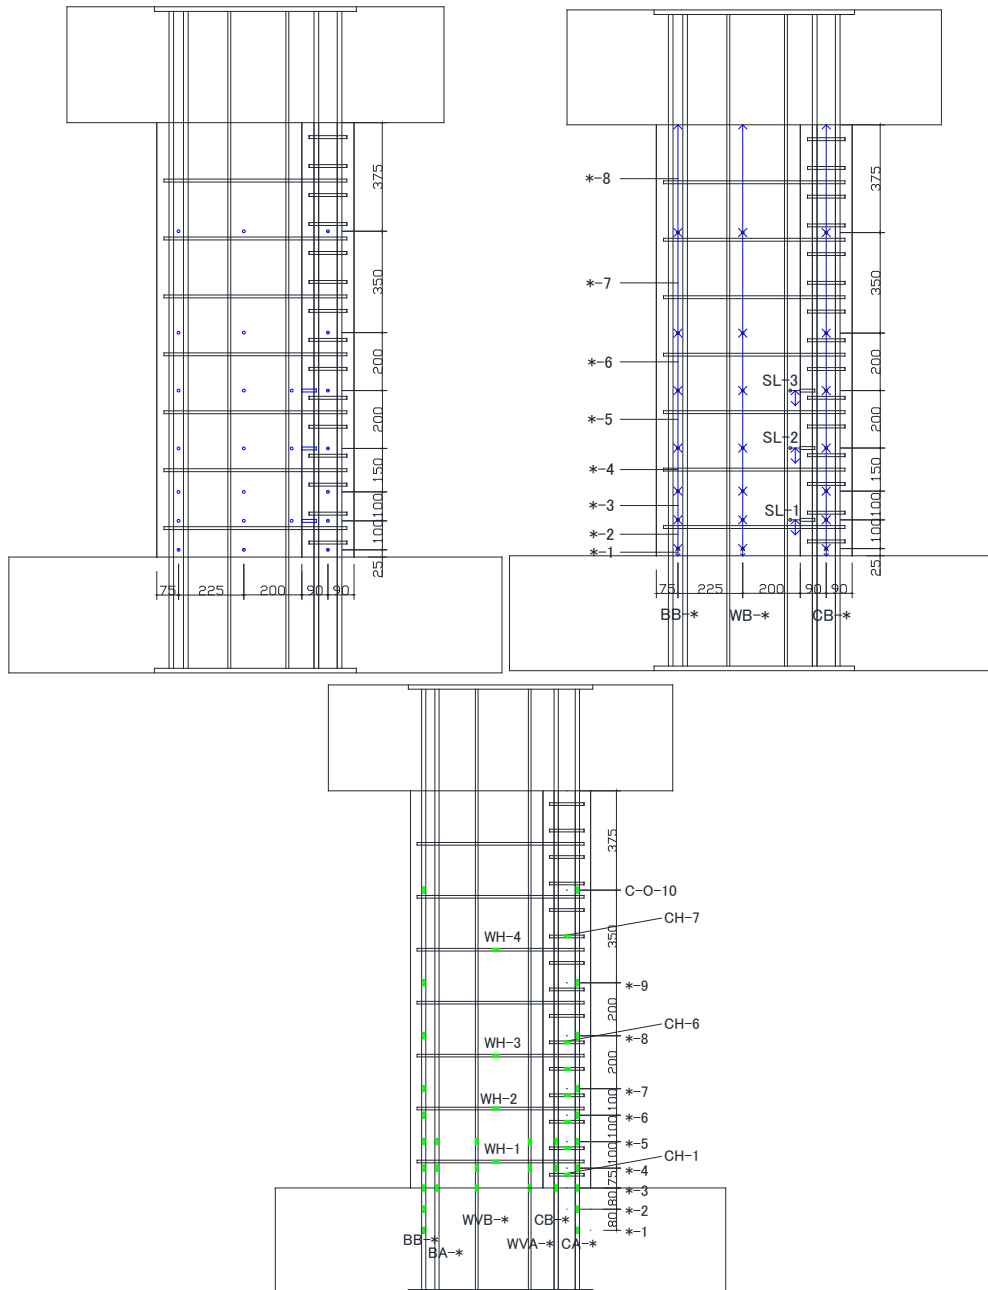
試験体 No.1 インサート，変位計，ひずみゲージ位置説明図
